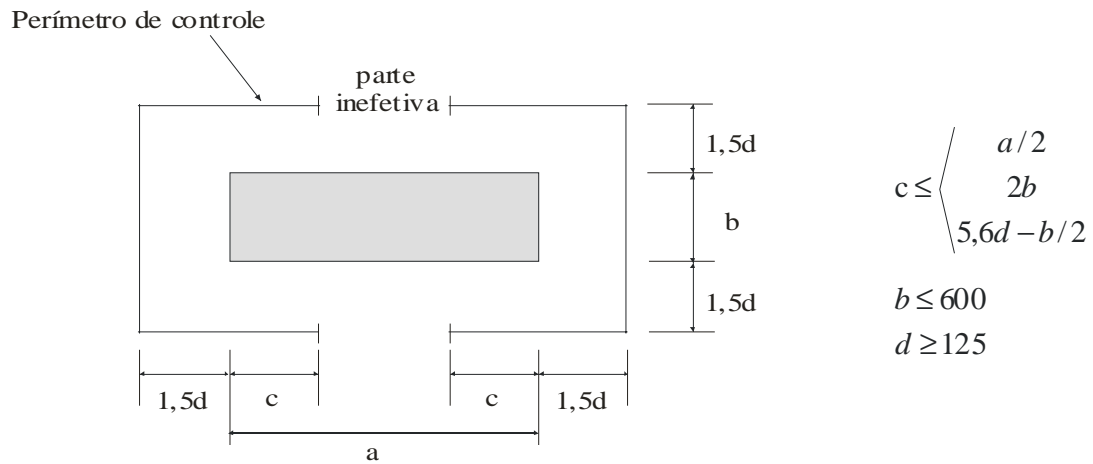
Perímetro crítico, para o cálculo de lajes sem armadura de cisalhamento e sem furos, recomendado por TENG et al.
